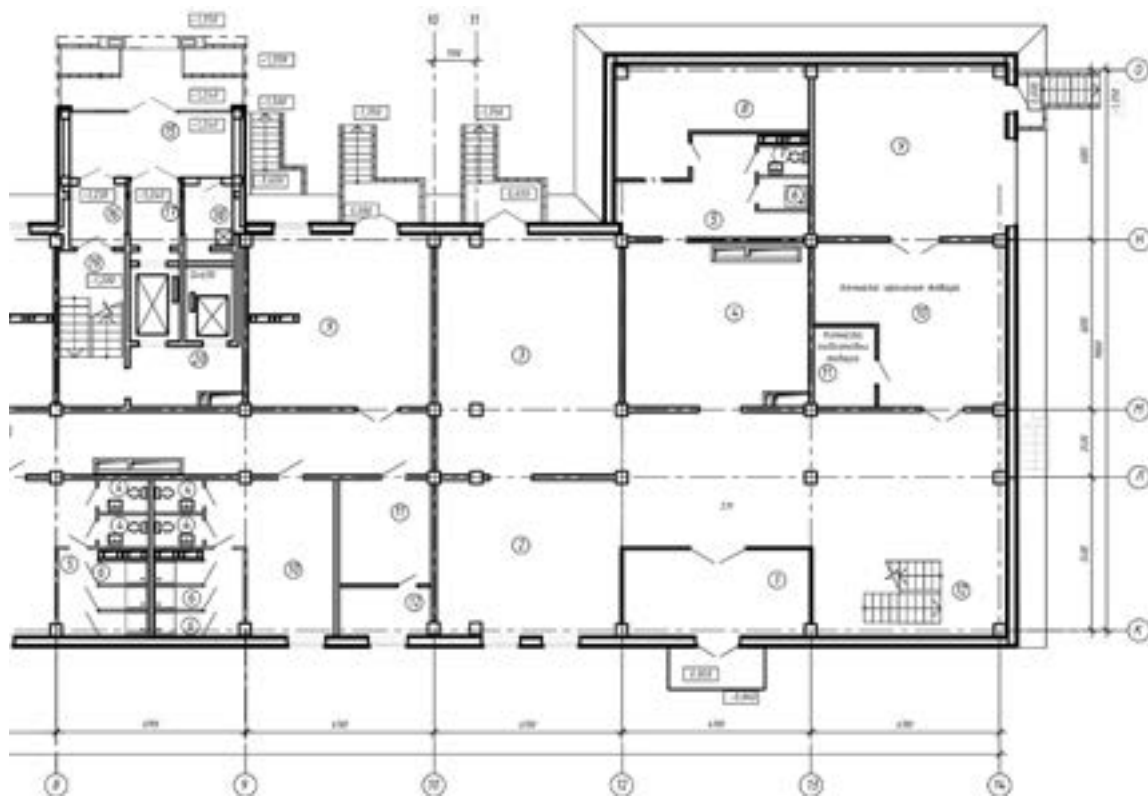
План первого этажа жилого дома системы КУПАСС с размещением помещений соцкультбыта
